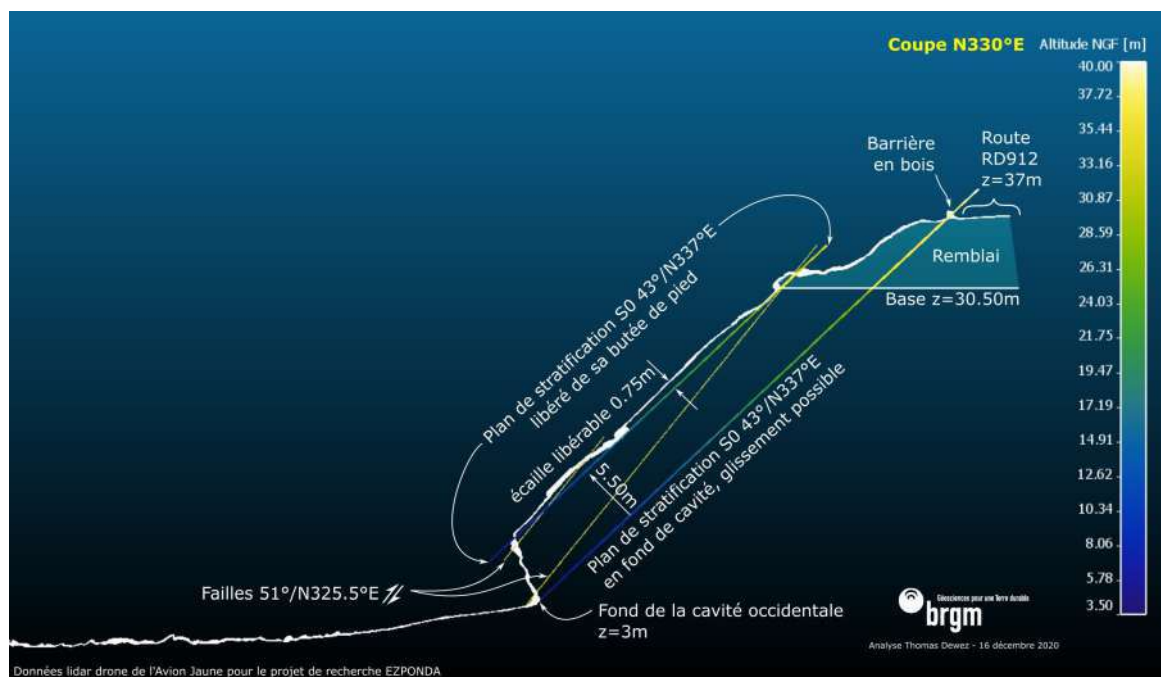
Coupe transversale, dans le tronçon 5, à travers la cavité occidentale (voir Illustration 11) (La suppression de la butée de pied libère une écaille de 0,75 m d'épaisseur. Non retenue, cette écaille peut s'écrouler à tout moment. Le plan stratigraphique passant par le fond de la cavité pourrait également accommoder une rupture en glissement "banc sur banc" ; l'épaisseur de roche ainsi délimitée depuis le fond de la cavité mesure 5,50 m d'épaisseur ; elle rejoindrait la bordure nord de la RD 912 en cas de déstabilisation ; scénario jugé peu probable à très court terme (données l'Avion Jaune pour le projet EZPONDA).)
